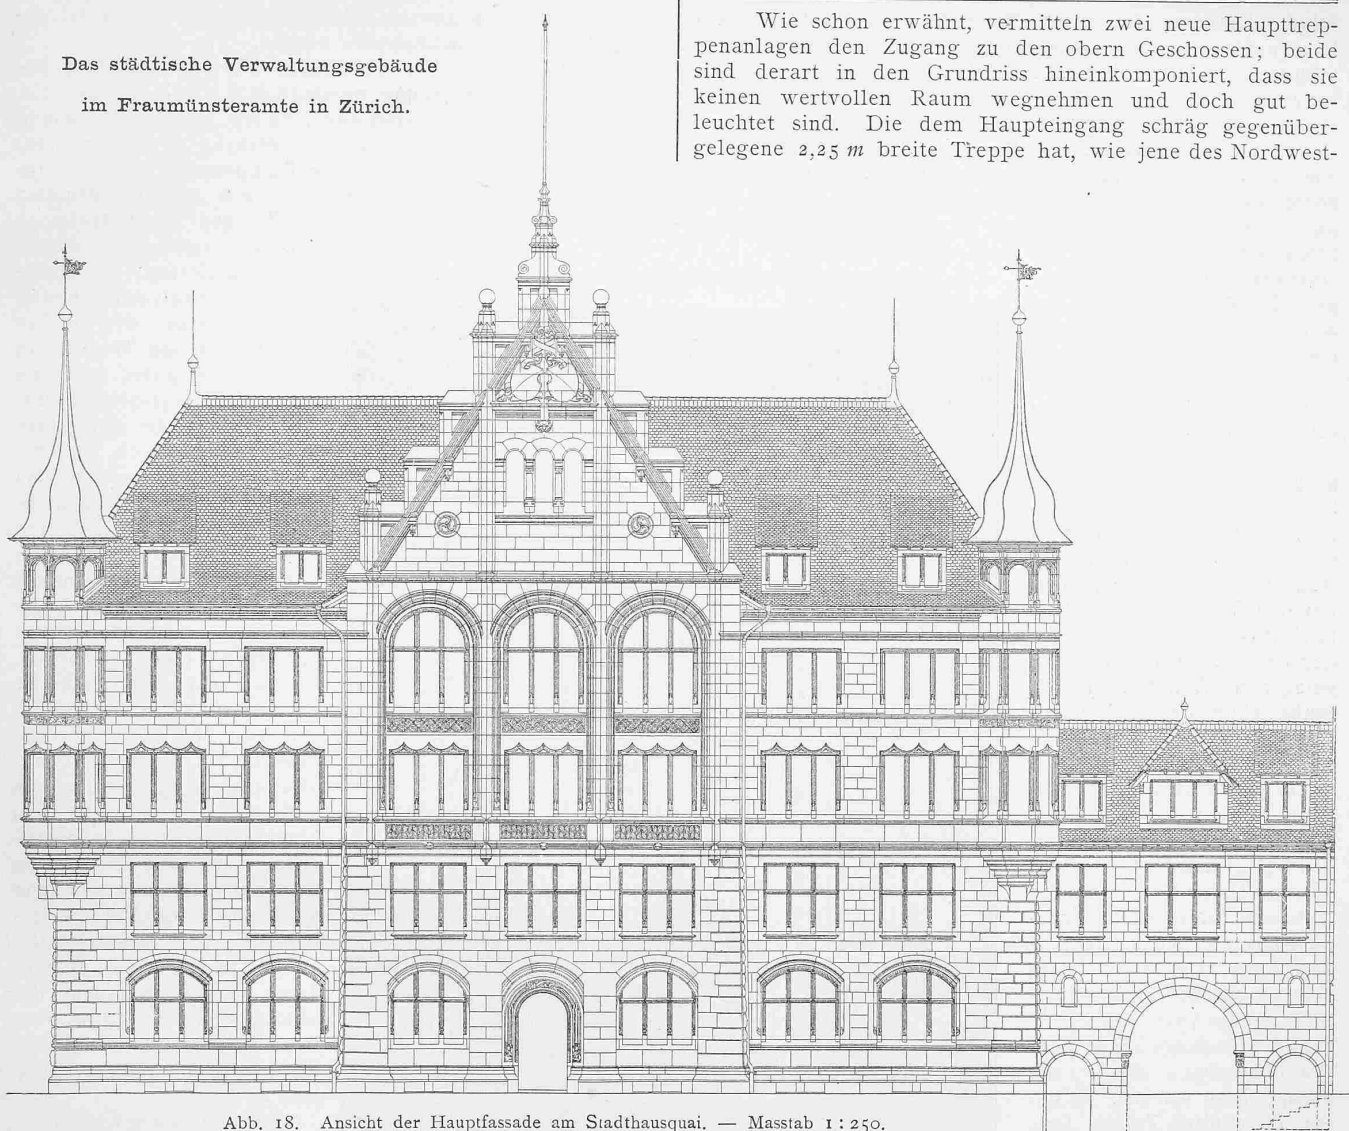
Ansicht der Hauptfassade am Stadthausquai. — Masstab 1 : 250.
